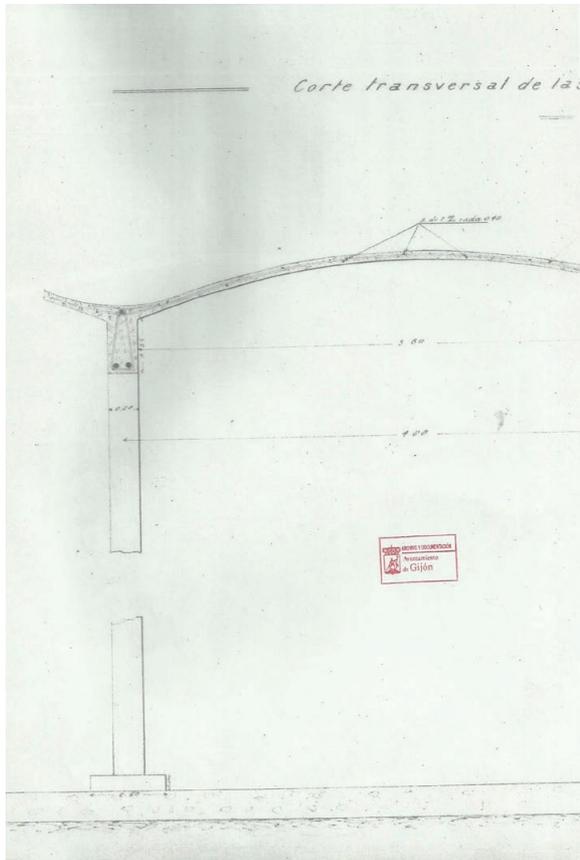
Nueva cubierta para el depósito de Gijón. Bóvedas rebajadas y apoyos. 1903. Archivo Municipal de Gijón. Expediente N° 132.
